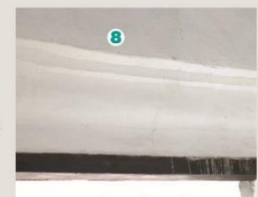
Vista de sección 6, alterado con nuevo aplanado y pintura, presenta suciedad en las esquinas superiores de muro y humedad capilar en la zona inferior.
